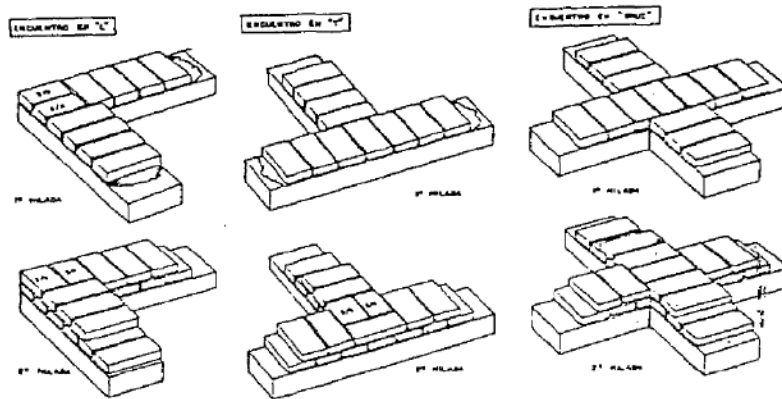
TIPOS DE AMARRE CON ADOBES RECTANGULARES
